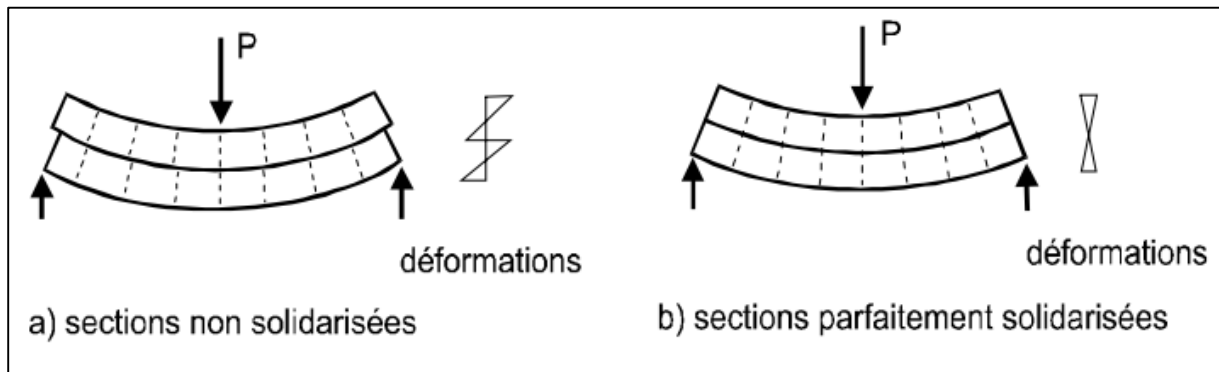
Le comportement d'une dalle mixte et non mixte
